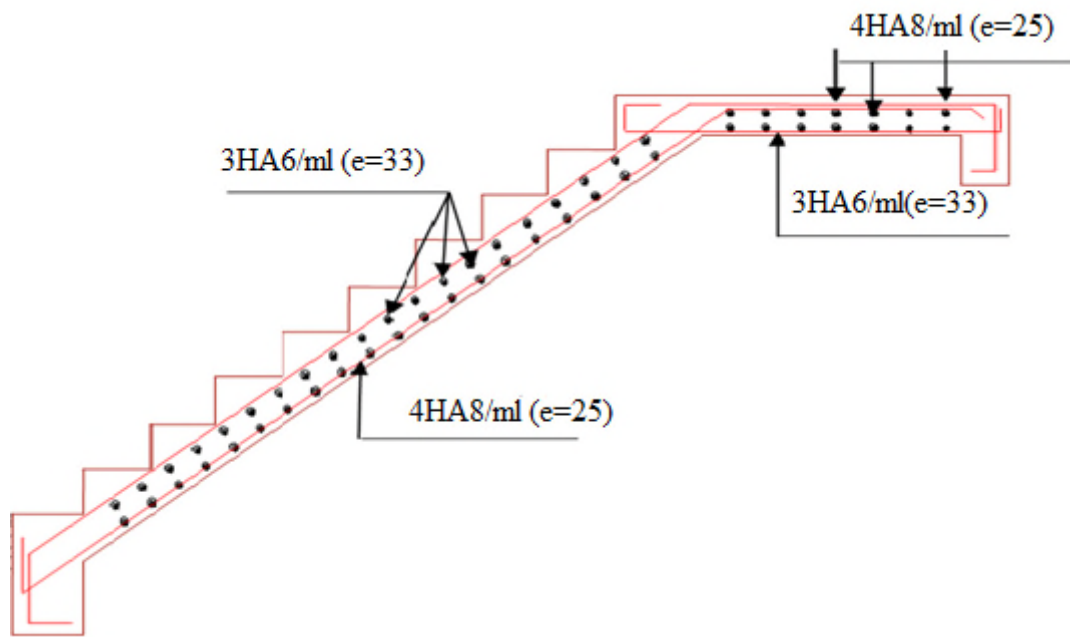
Schéma de ferrailage de l'escalier Type 2
